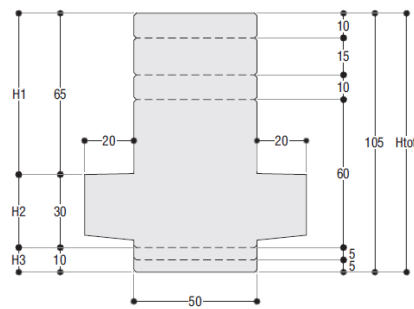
Pilar prefabricat amb mènscula. (Font: Prefabricats Planes, 2017).
